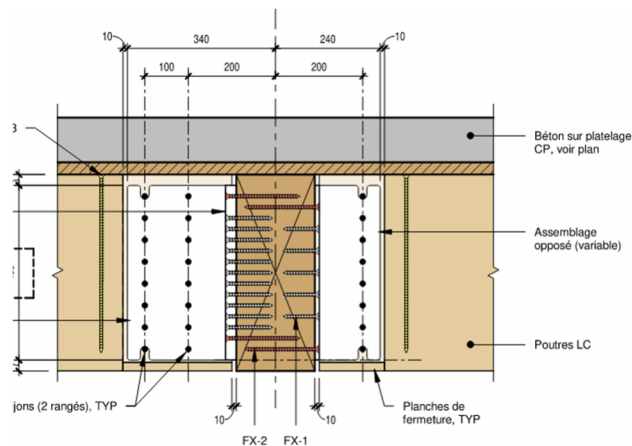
Extrait des plans pour construction en structure. Étrier standard typique
